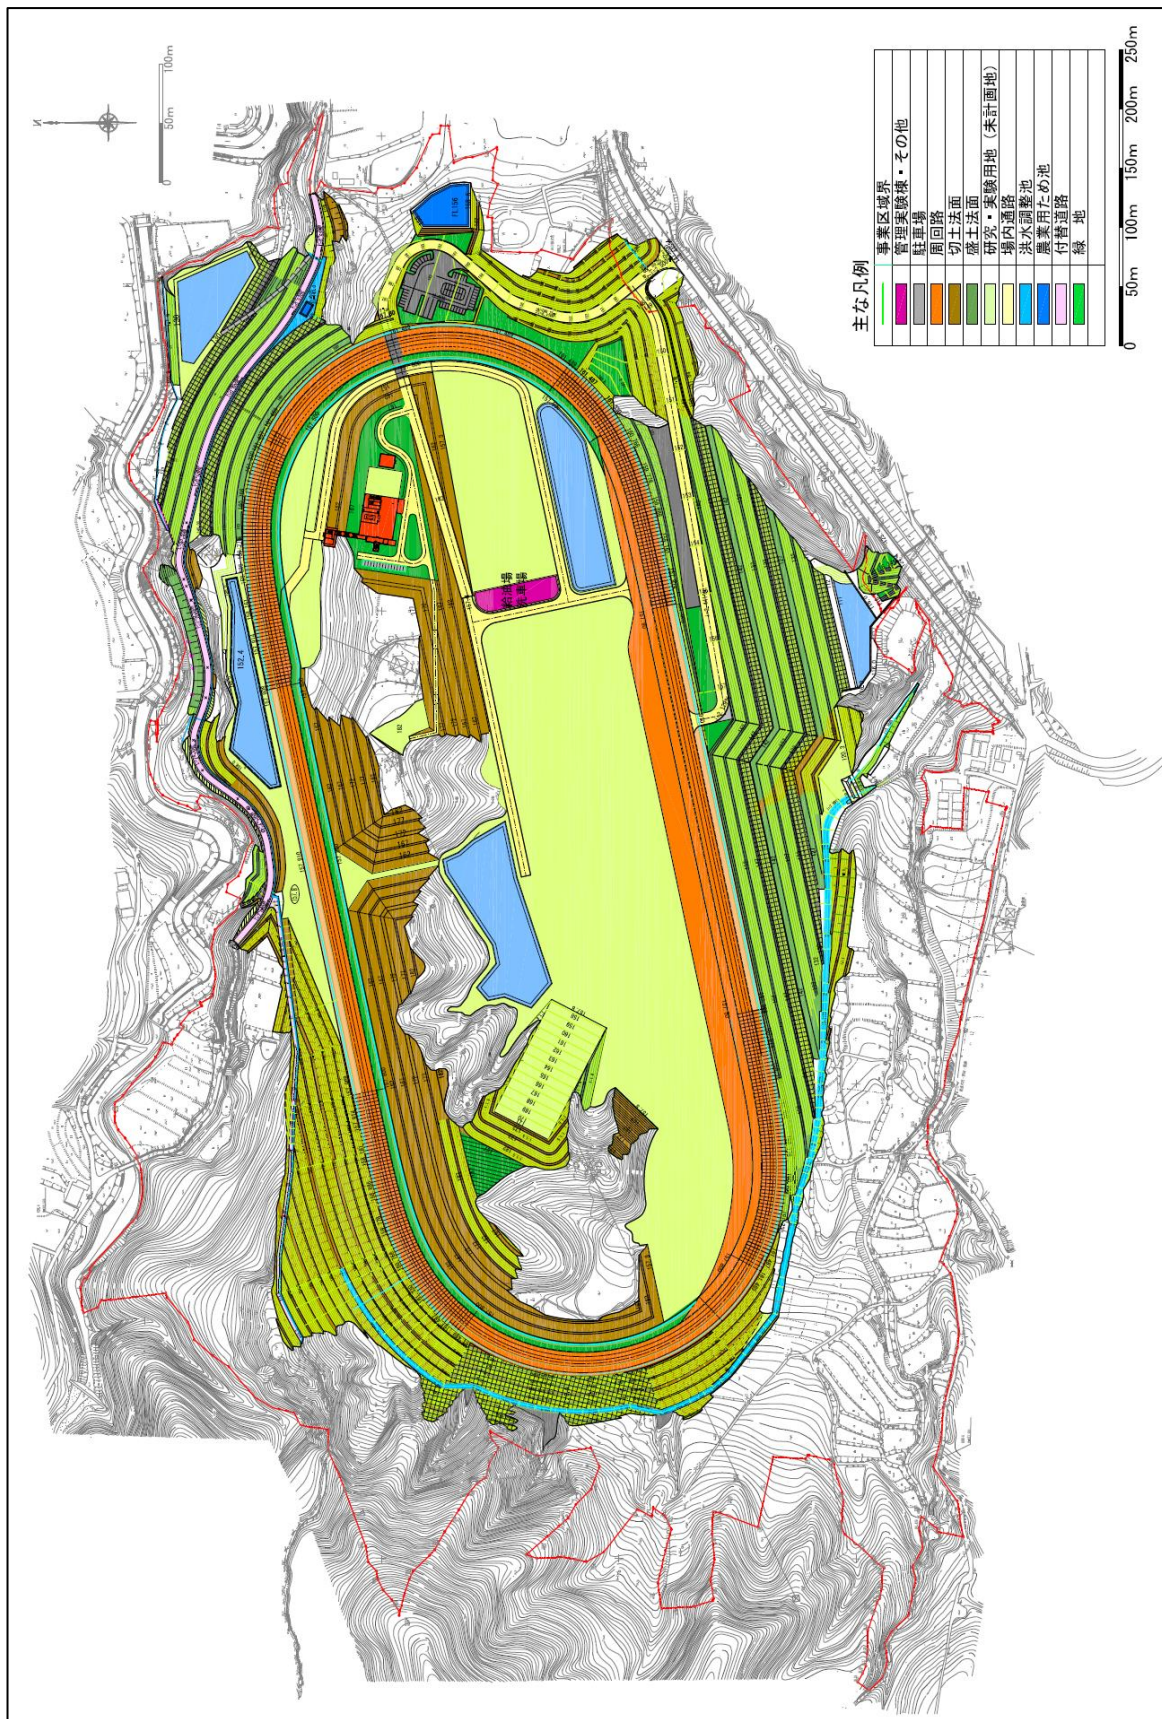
土地利用計画平面図 (環境影響評価書時点)
